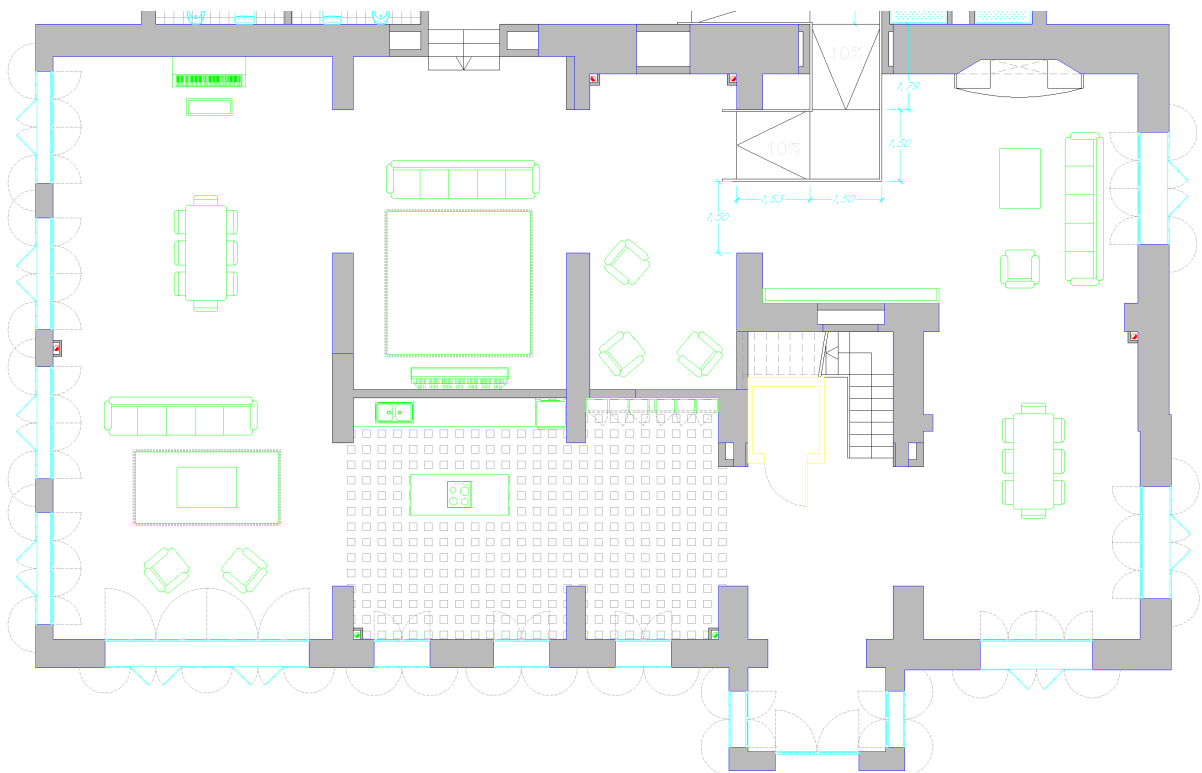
Plano planta baja (Fuente: Propia)
